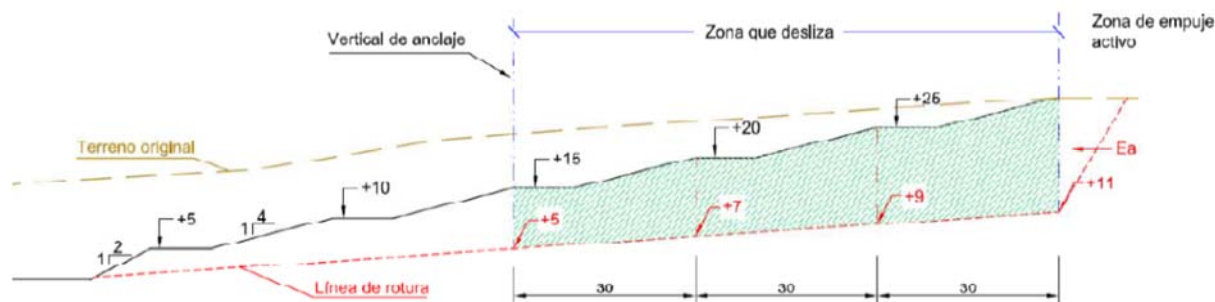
Esquema de desmonte utilizado para el cálculo del muro anclado
